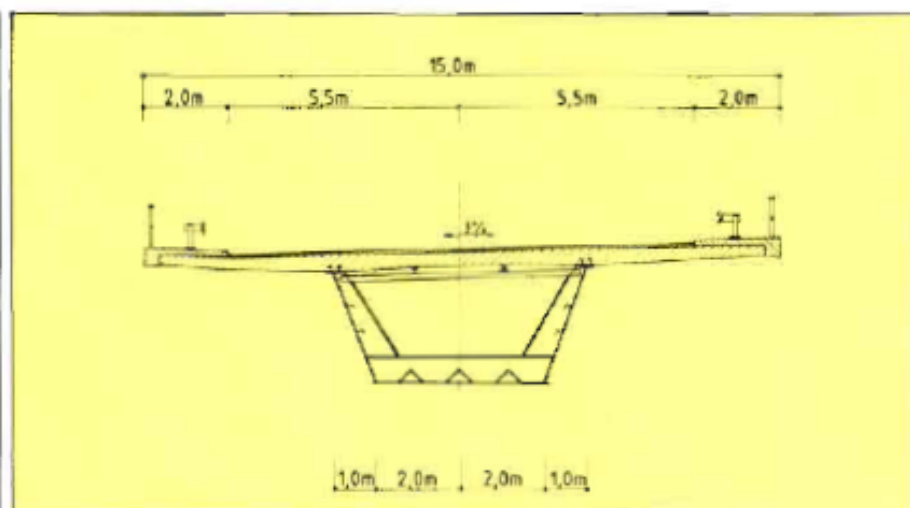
Puente sobre Autopista en Alemania con pretensado transversal.
